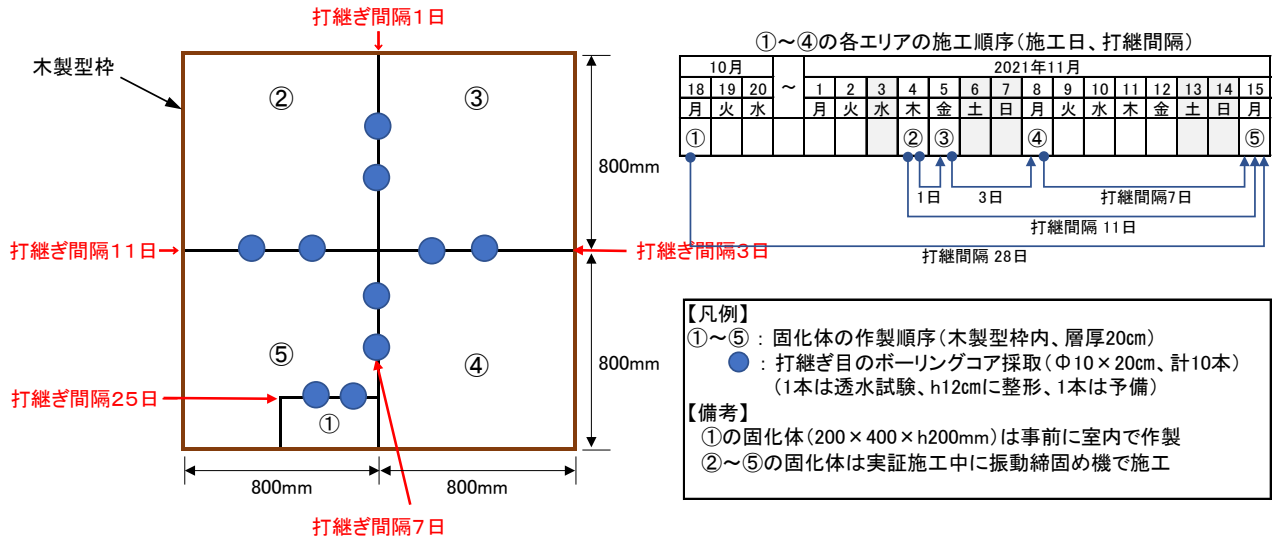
鉛直打継ぎ目の密着性確認実験の概要(平面図、施工順序)
